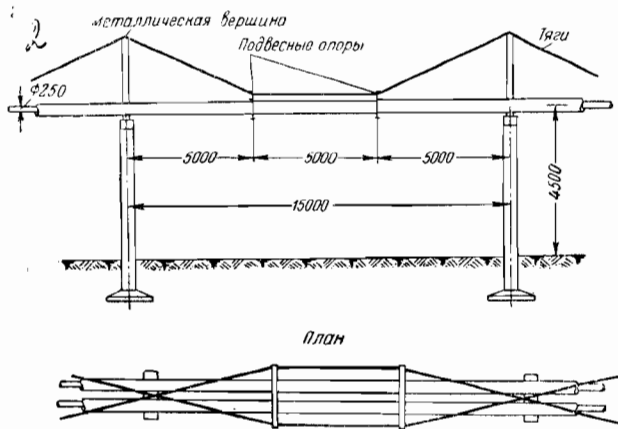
Надземный теплотрасс на железобетонных мачтах.
